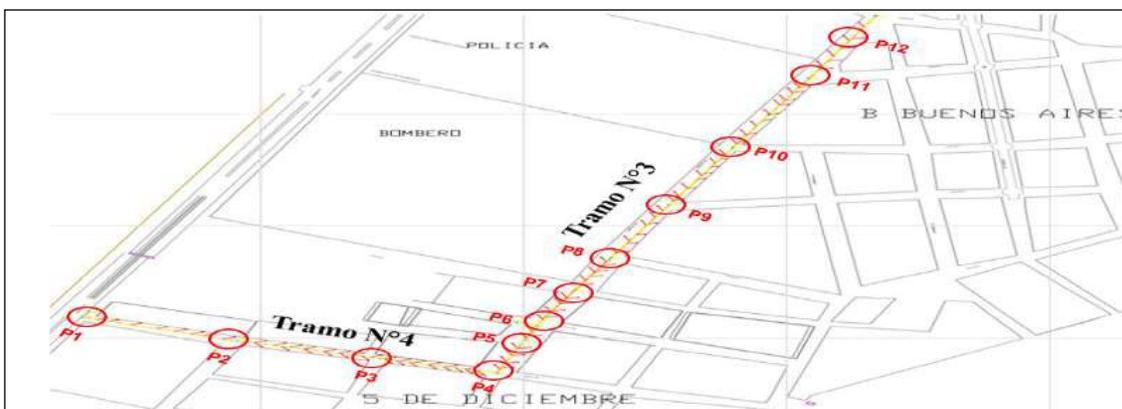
Plano De Instalación De Redes Sanitarias (Calle 4B entre Cra 16 y 14E) (Cra 14E Entre Calles 4B y 9).
